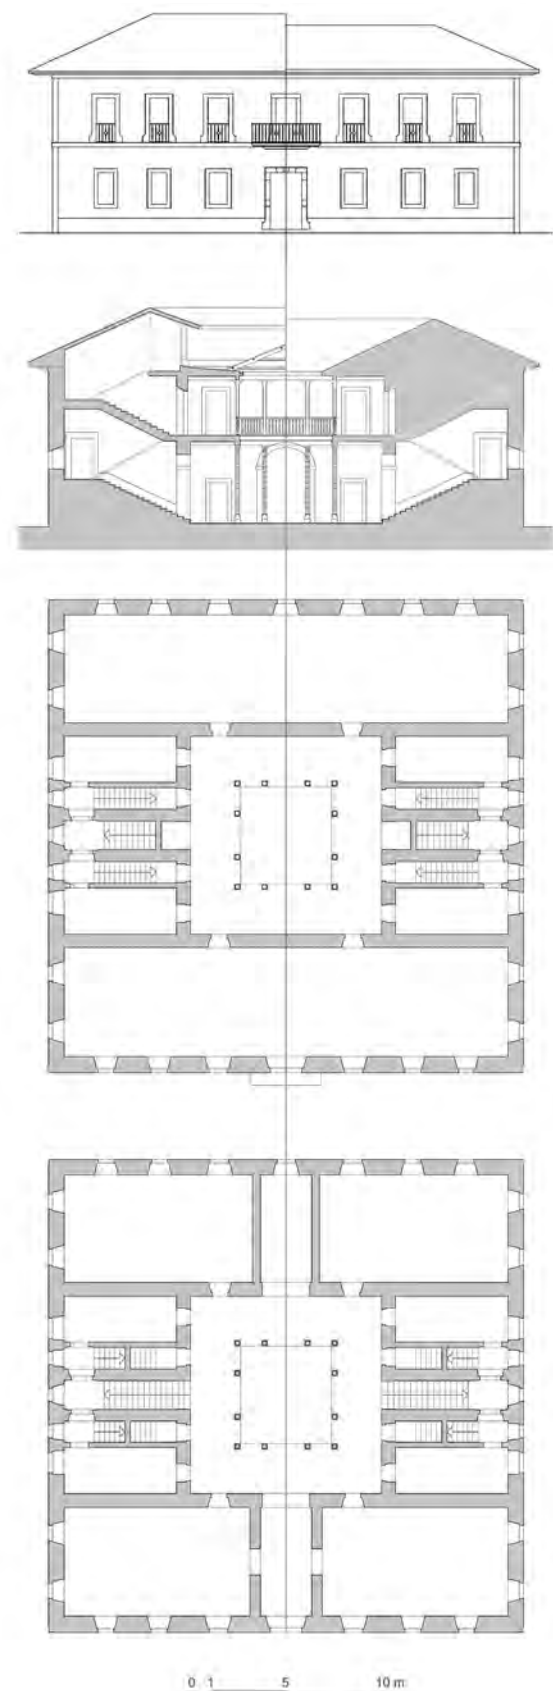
Plantas, sección y alzado del Ayuntamiento de Pravia, 2016, Javier Ortega; en la sección y el alzado, la mitad izquierda representa el estado actual
